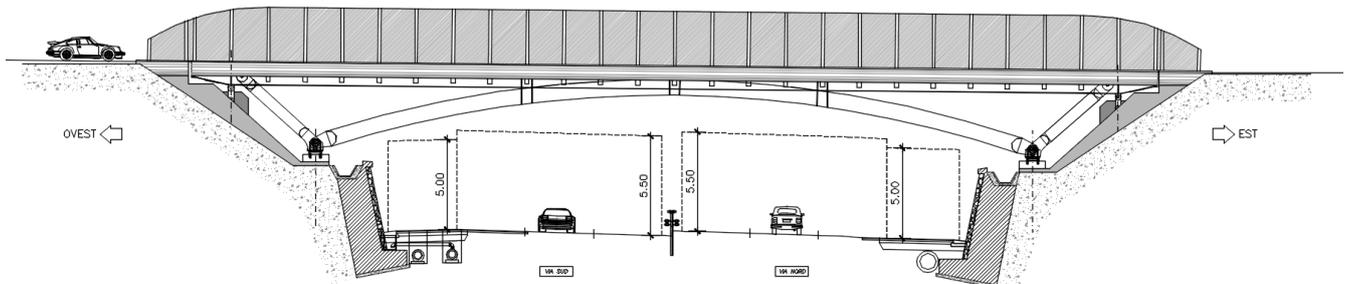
Sezione longitudinale del nuovo sovrappasso n. 68
